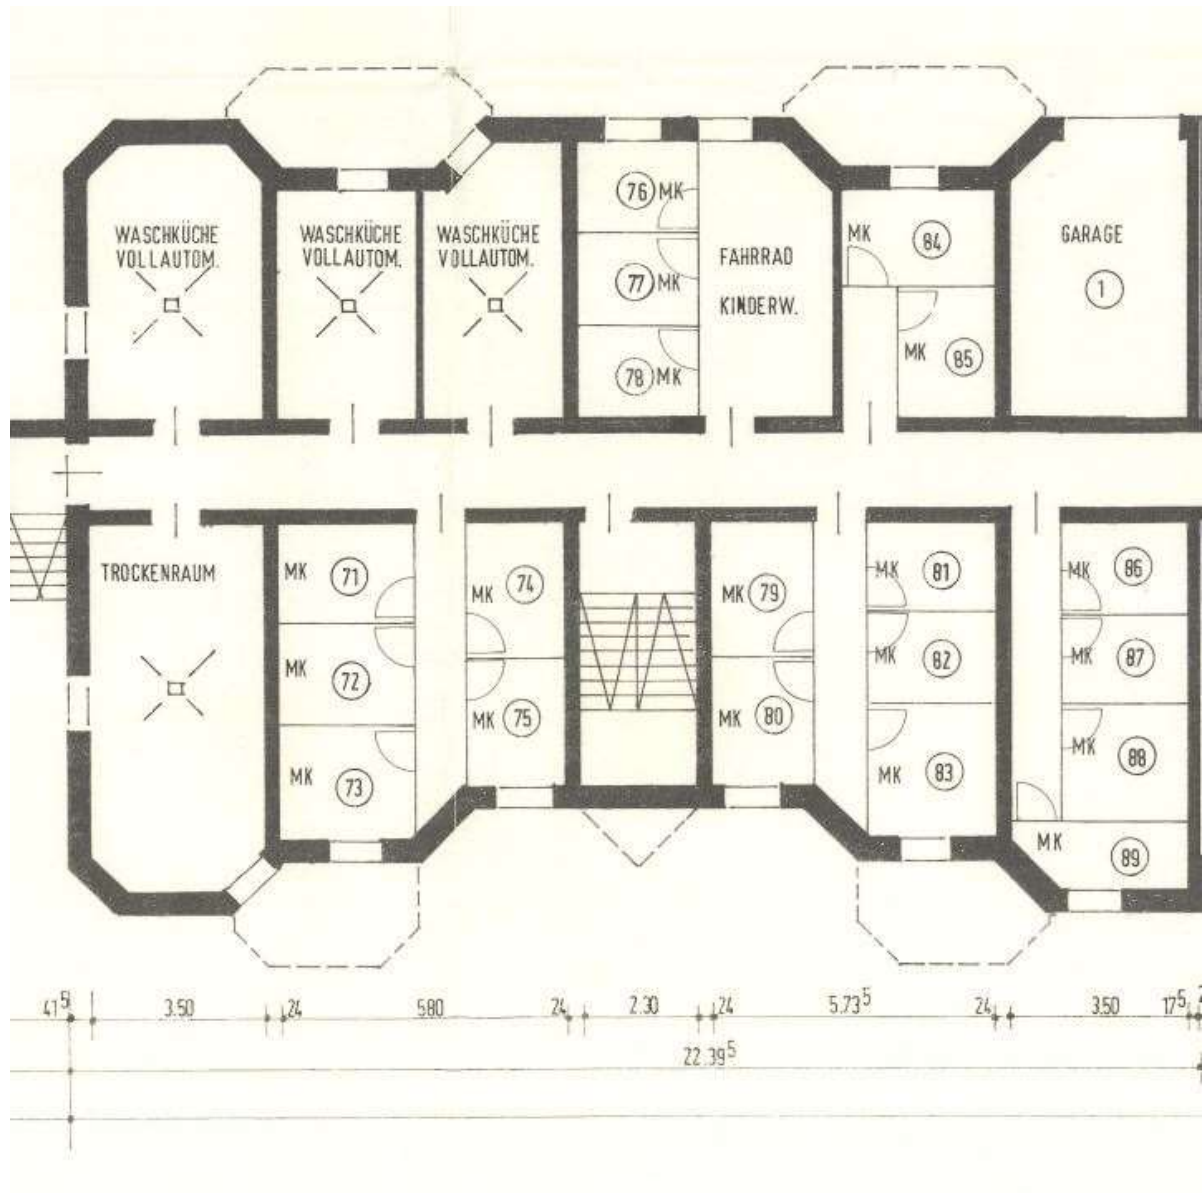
Kellergeschoss SE Nr. 79 Quelle: Bauakte AG Duisburg
